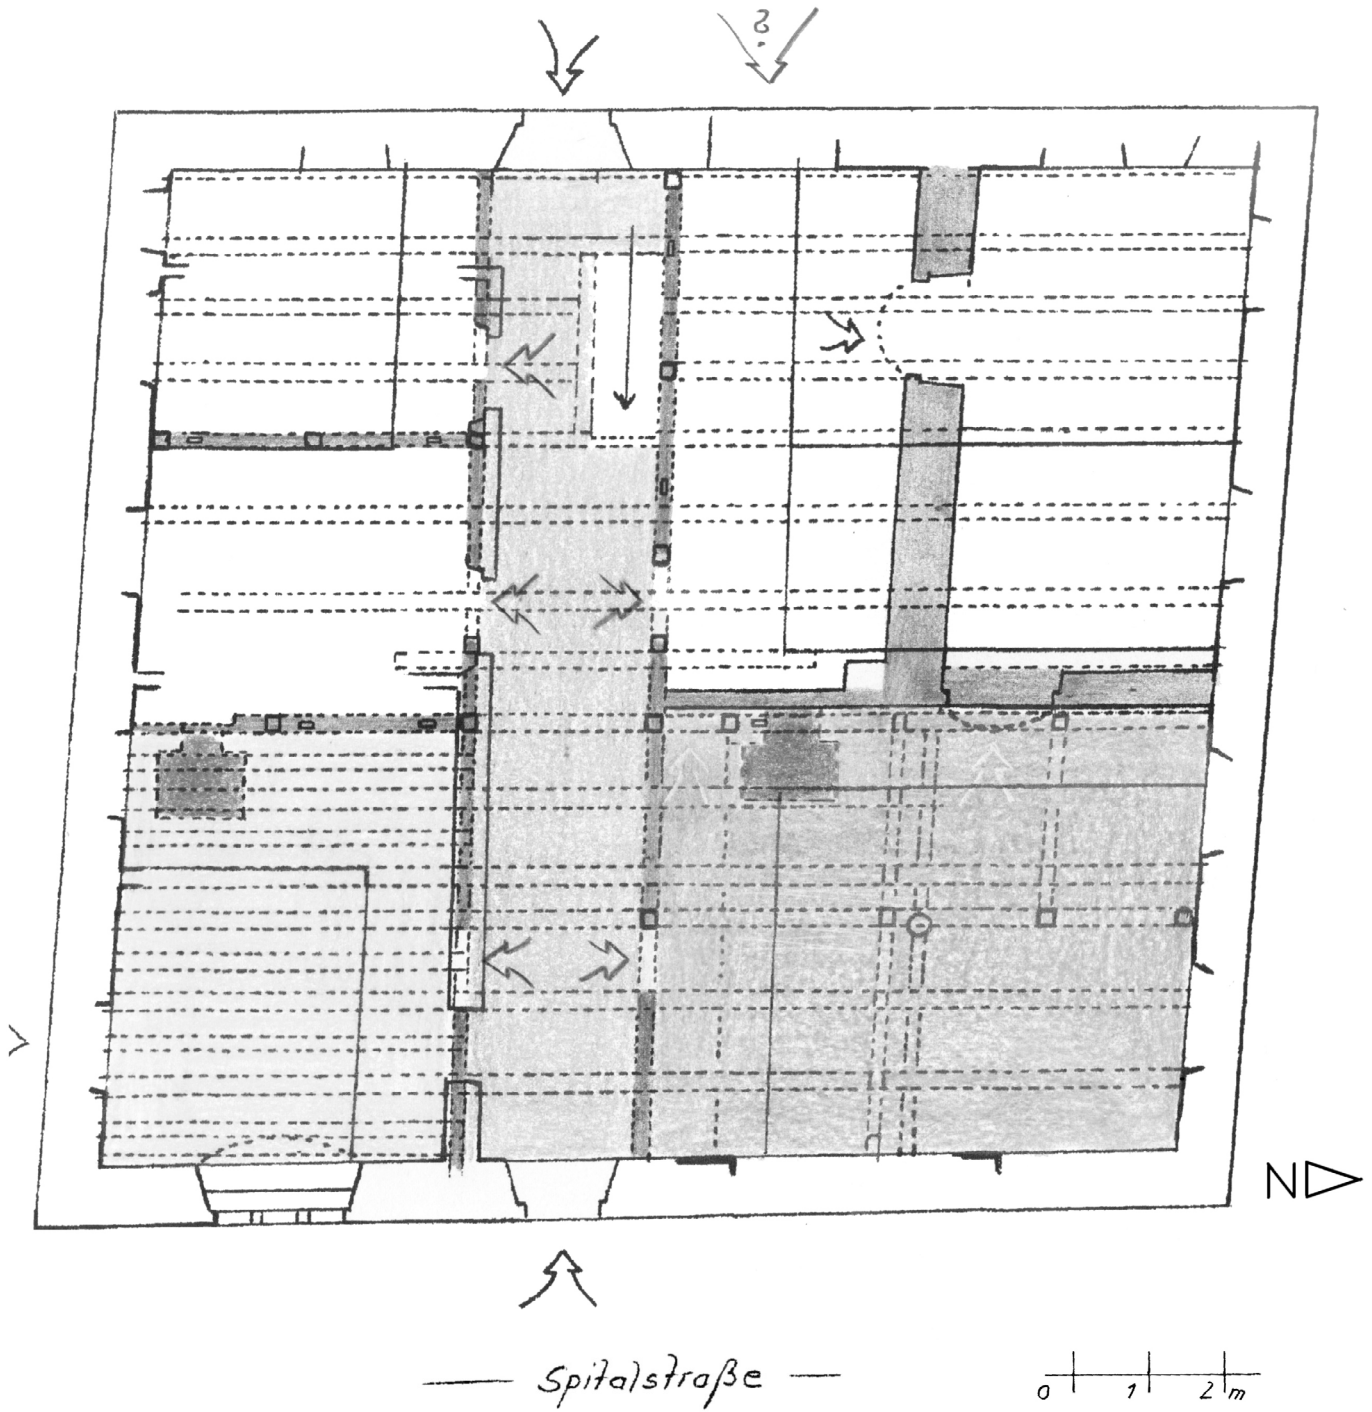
Spitalstraße 33, Grundriss Erdgeschoss, 18. Jh., Rekonstruktion.
